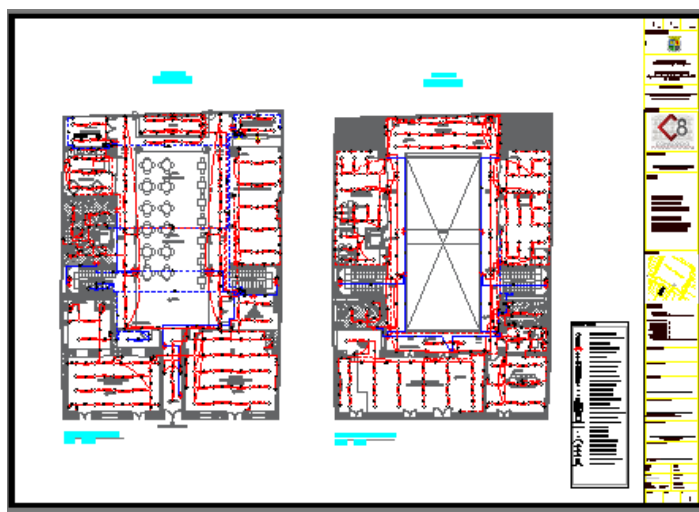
Plano distribución eléctrica. (Ver plano 1-3 de 4)
